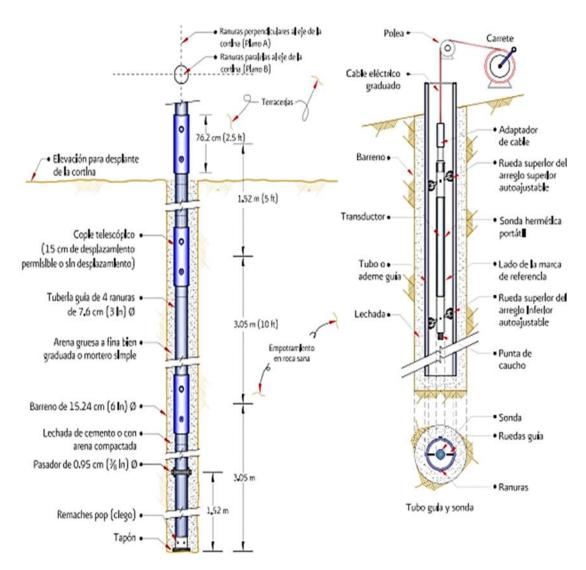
III.3.3.2.1 Detalle del anclaje de la tubería guía y componentes del inclinómetro vertical.
